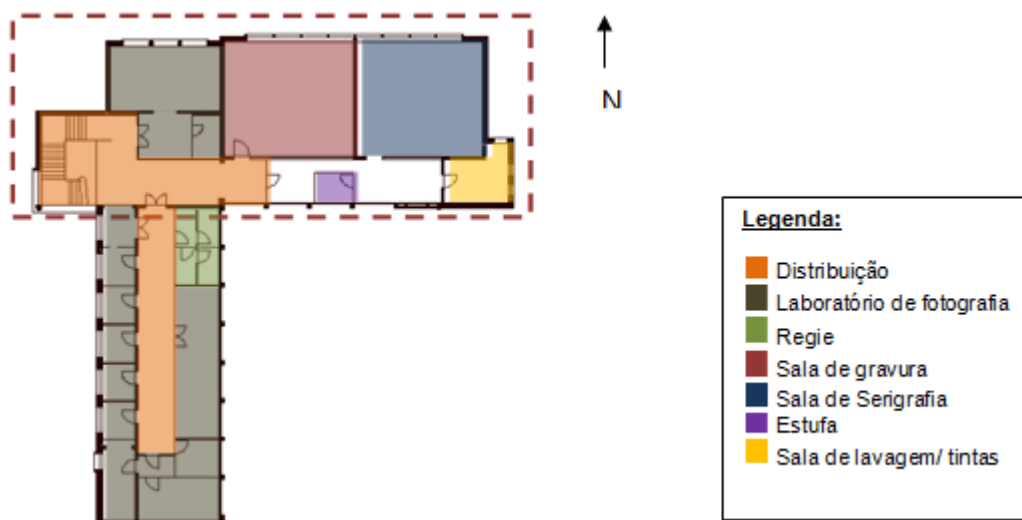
FBAUP-planta piso 1, pavilhão das tecnologias ^[32]
